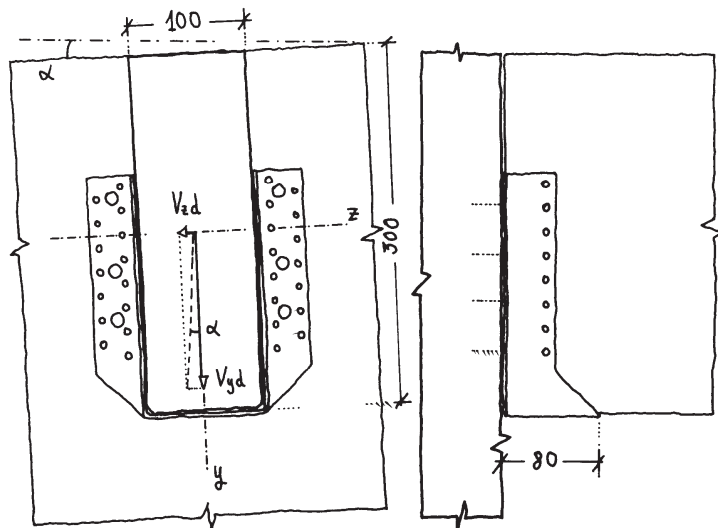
Ejemplo de apoyo de correa de madera laminada encolada.
